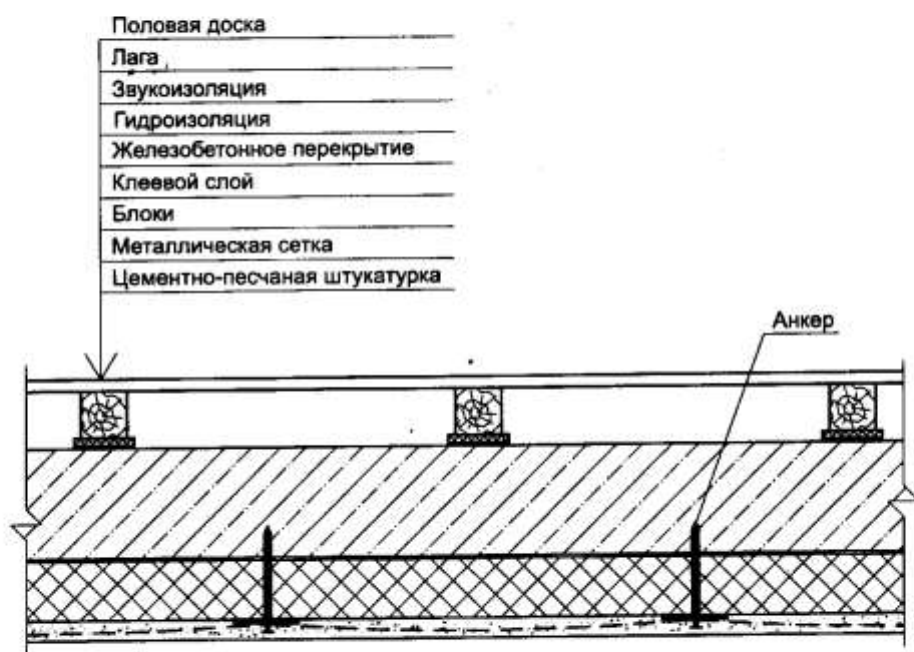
Наружная тепловая изоляция перекрытия с отделкой цементно-песчаным раствором
